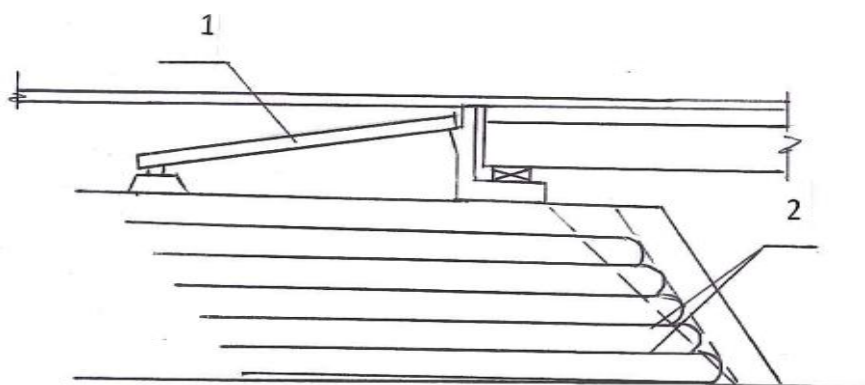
Применение геосинтетических полотен для армирования грунта насыпи: 1 – переходная плита; 2- геосинтетические полотна
